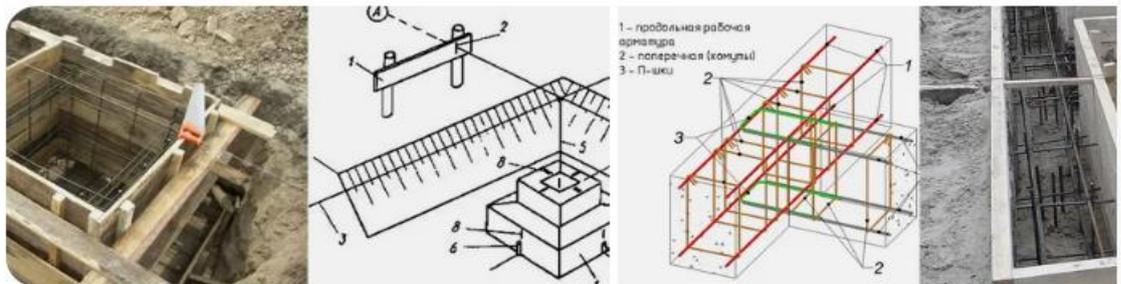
Этапы подготовки к бетонированию: установка опалубки и армирование
